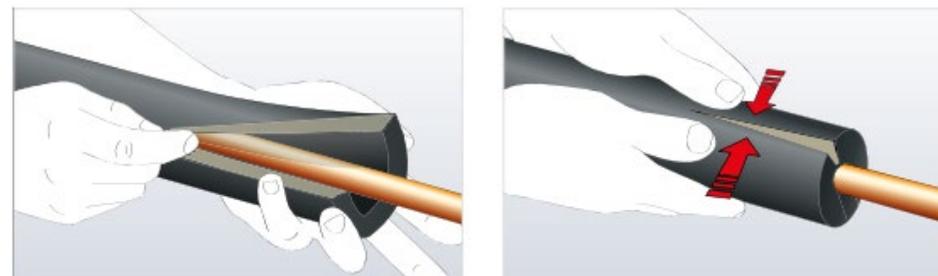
Laisser sécher la colle et presser les plans de joint encollés
